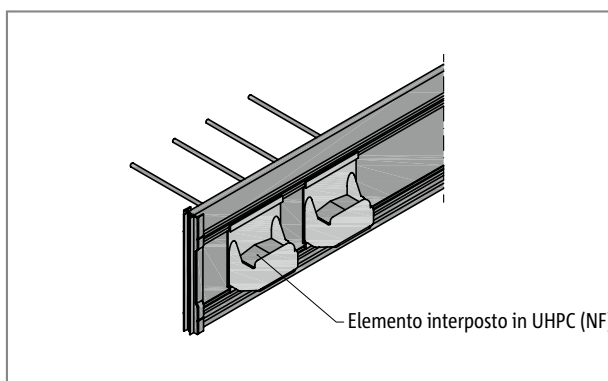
Schöck Tronsole® tipo T: dettaglio della mensola di supporto; fabbricazione inversa
